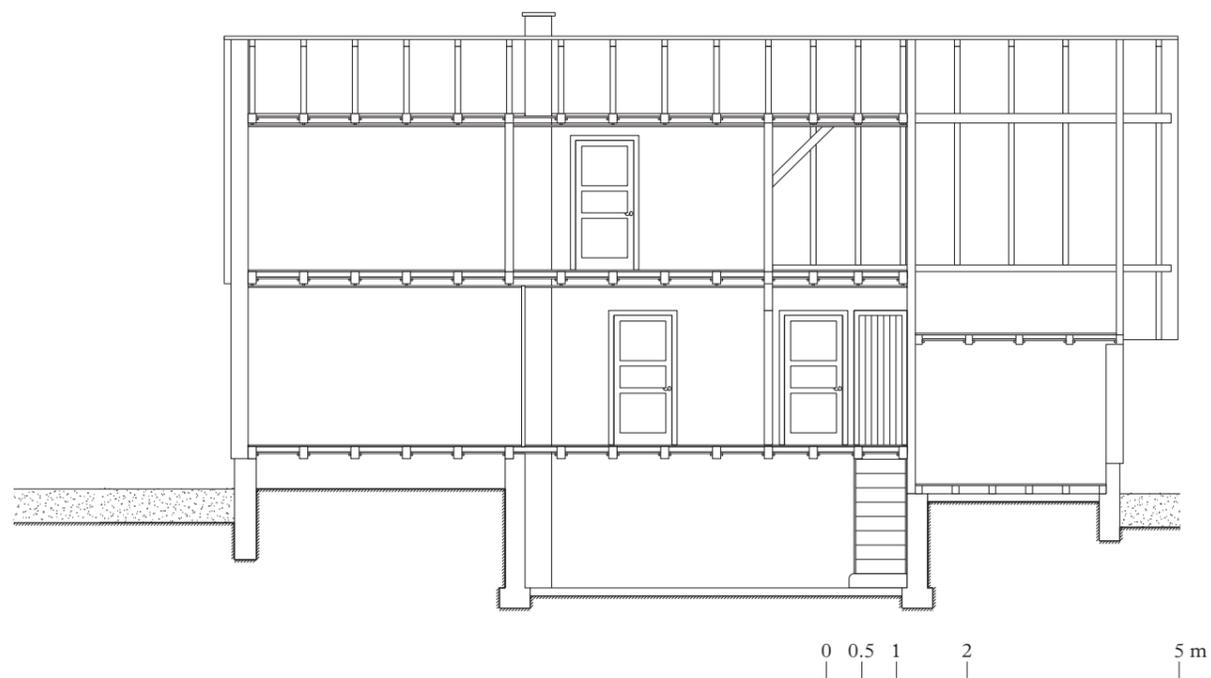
Tschabrun, A. (1935, novembre). Redessin de la coupe constructive longitudinale d'une maison de type III. [Coupe, 1:100]. Dossier de construction. Archives de la ville de Weil-am-Rhein.
